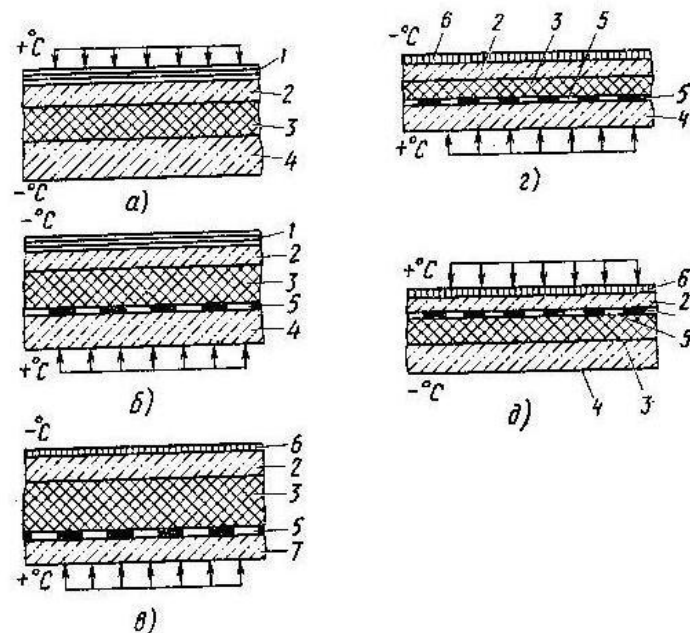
Схемы тепло- и пароизоляции зданий холодильников:
